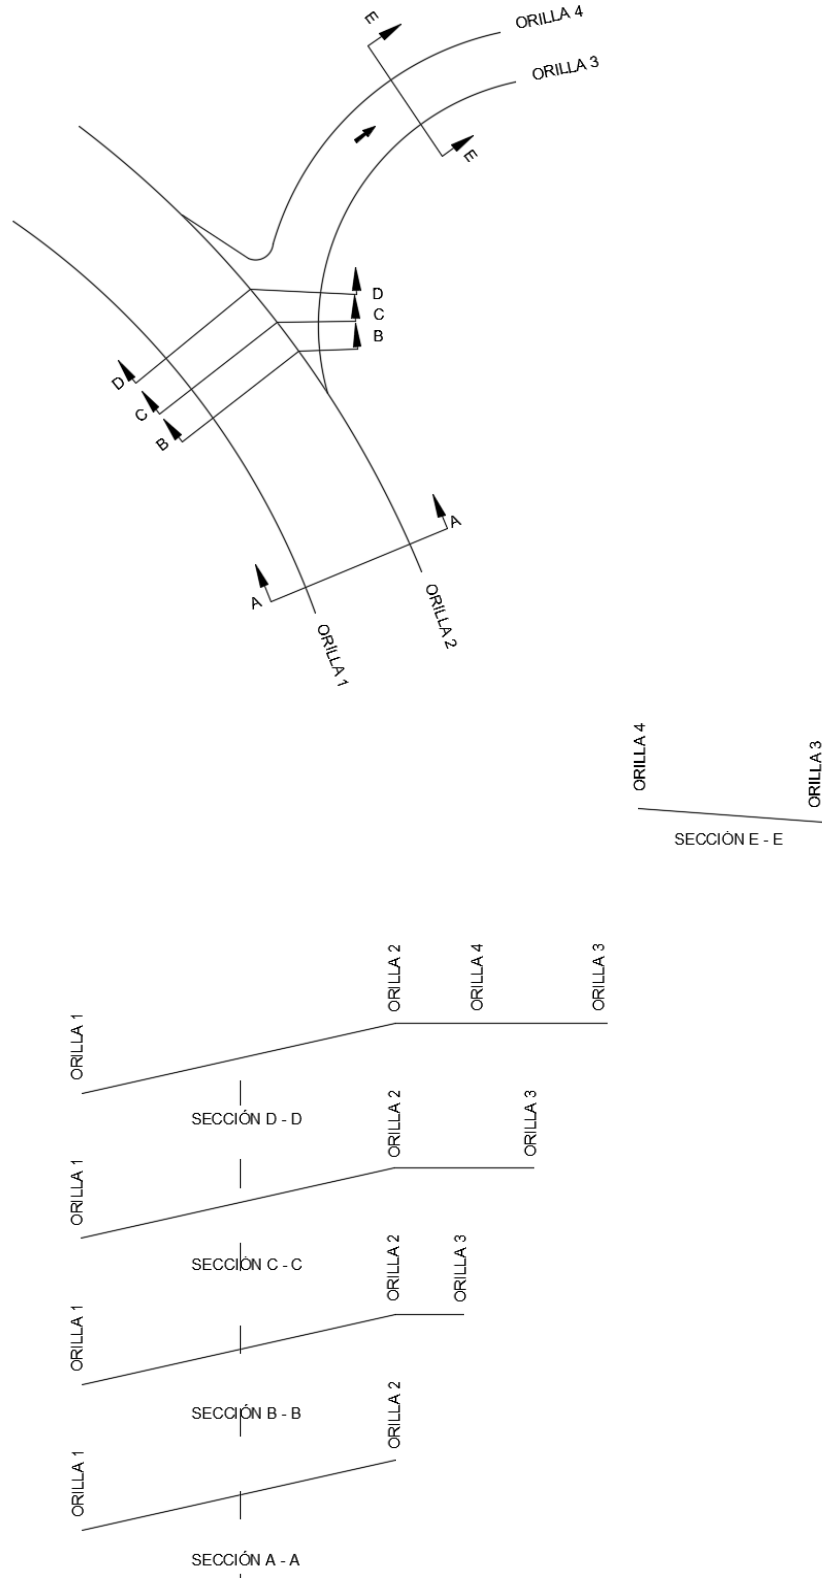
Desarrollo de la sobreelevación de salidas de carreteras
